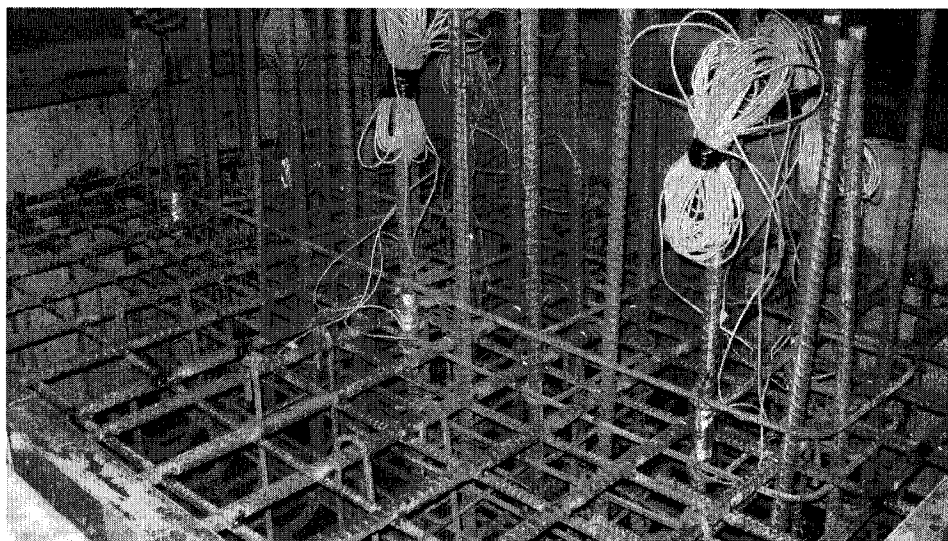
Cage d'armature et coffrage de la semelle 4
